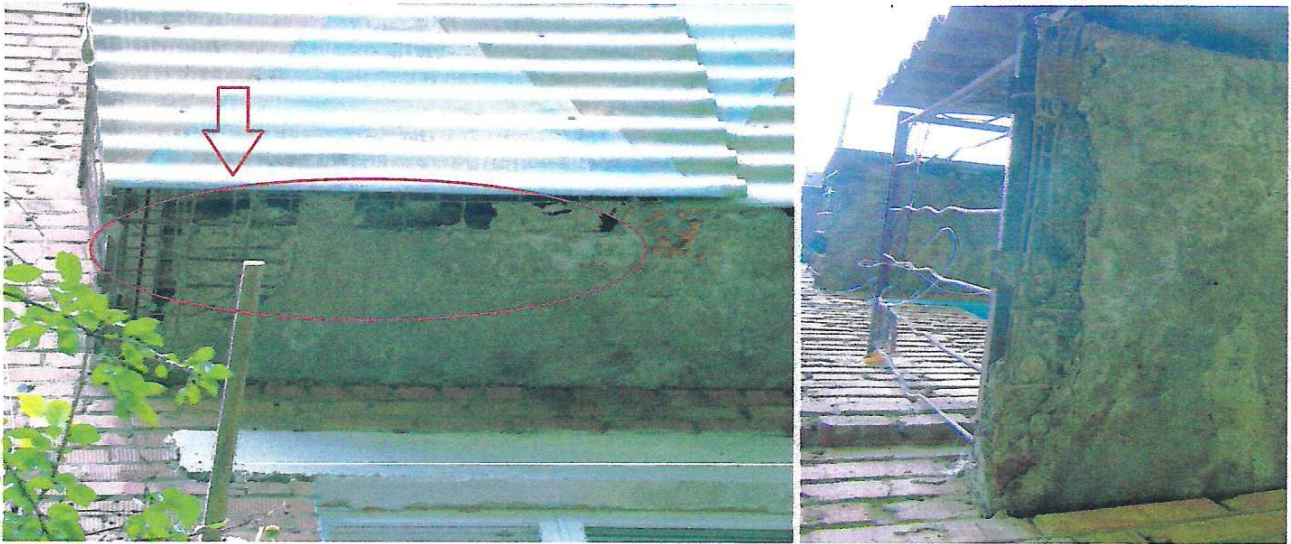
Дефекты балконов. Частично разрушена плита, оголение арматуры.
